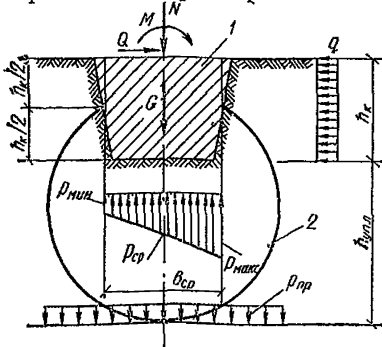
Схема к расчету столбчатого фундамента в вытрамбованном котловане
